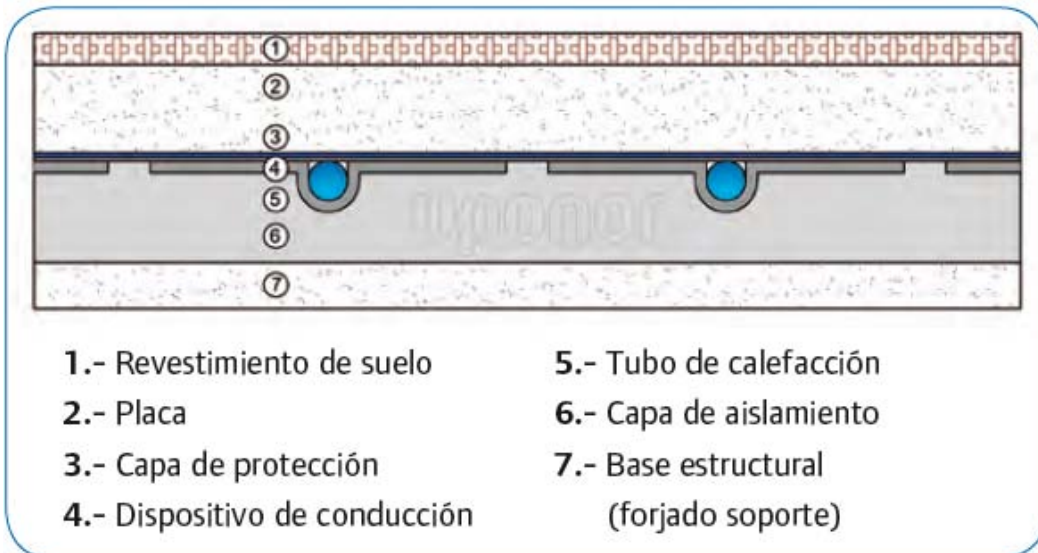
2 Sistema con los tubos por debajo del pavimento tipo B
